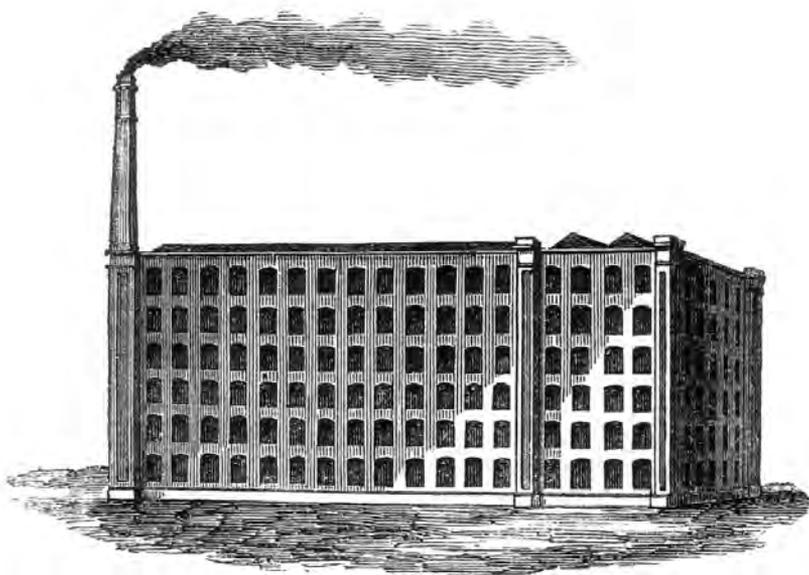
Фасад фабричного здания В. Фейрбейрна
